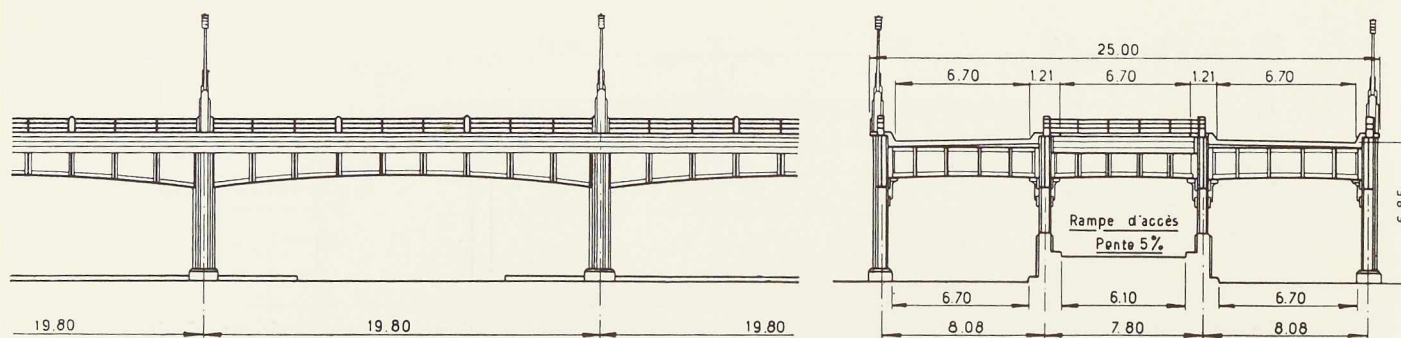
Elévation et coupe du projet de M. W. W. Jones. On notera que les rampes d'accès se trouvent au milieu de l'ouvrage.
